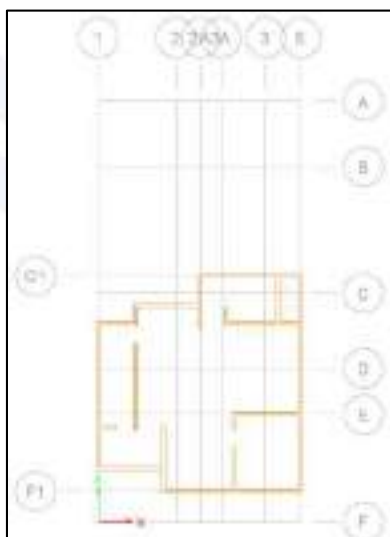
Columnas estructurales Bouganviles, Casa 14 - Altílo
